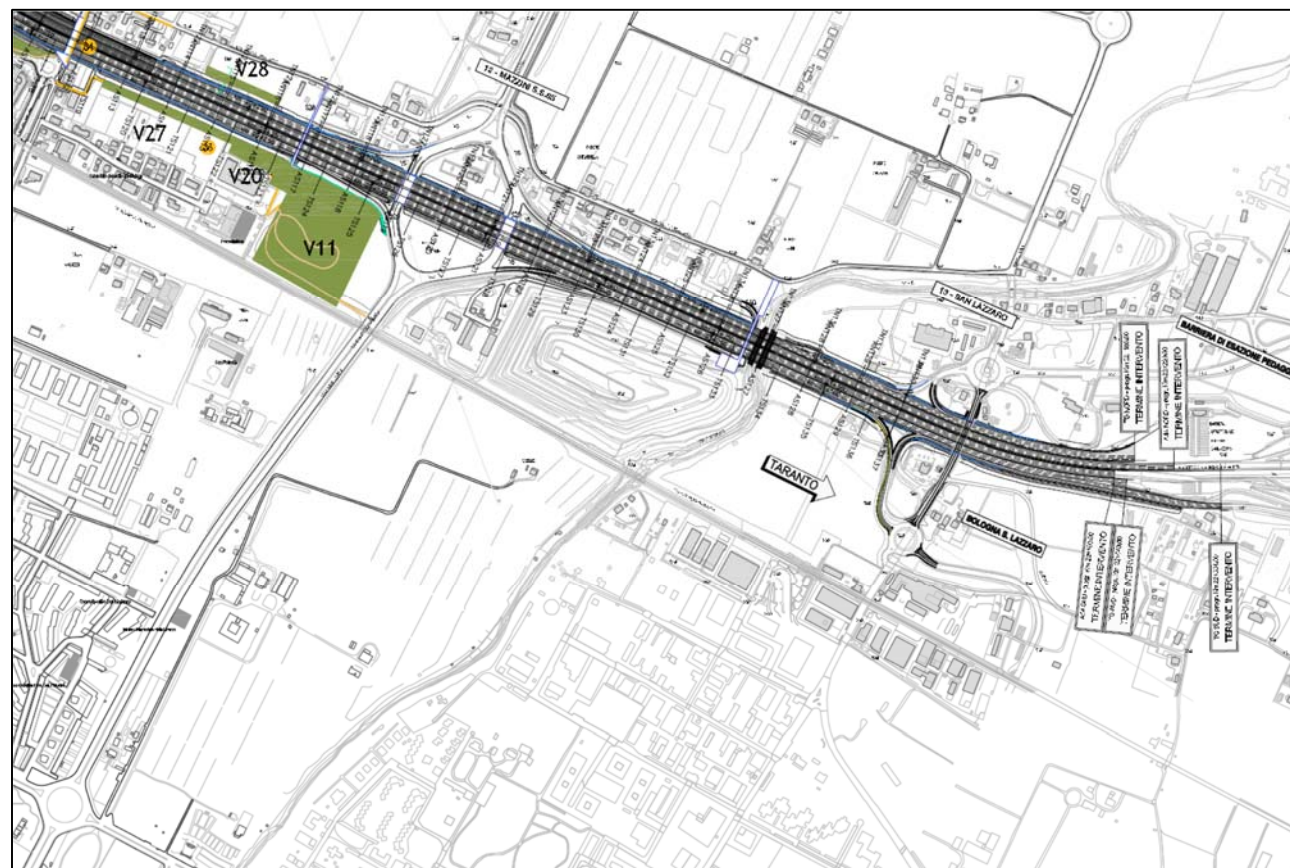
Dettaglio planimetrico Svincoli 12 – Mazzini e 13 – San Lazzaro
